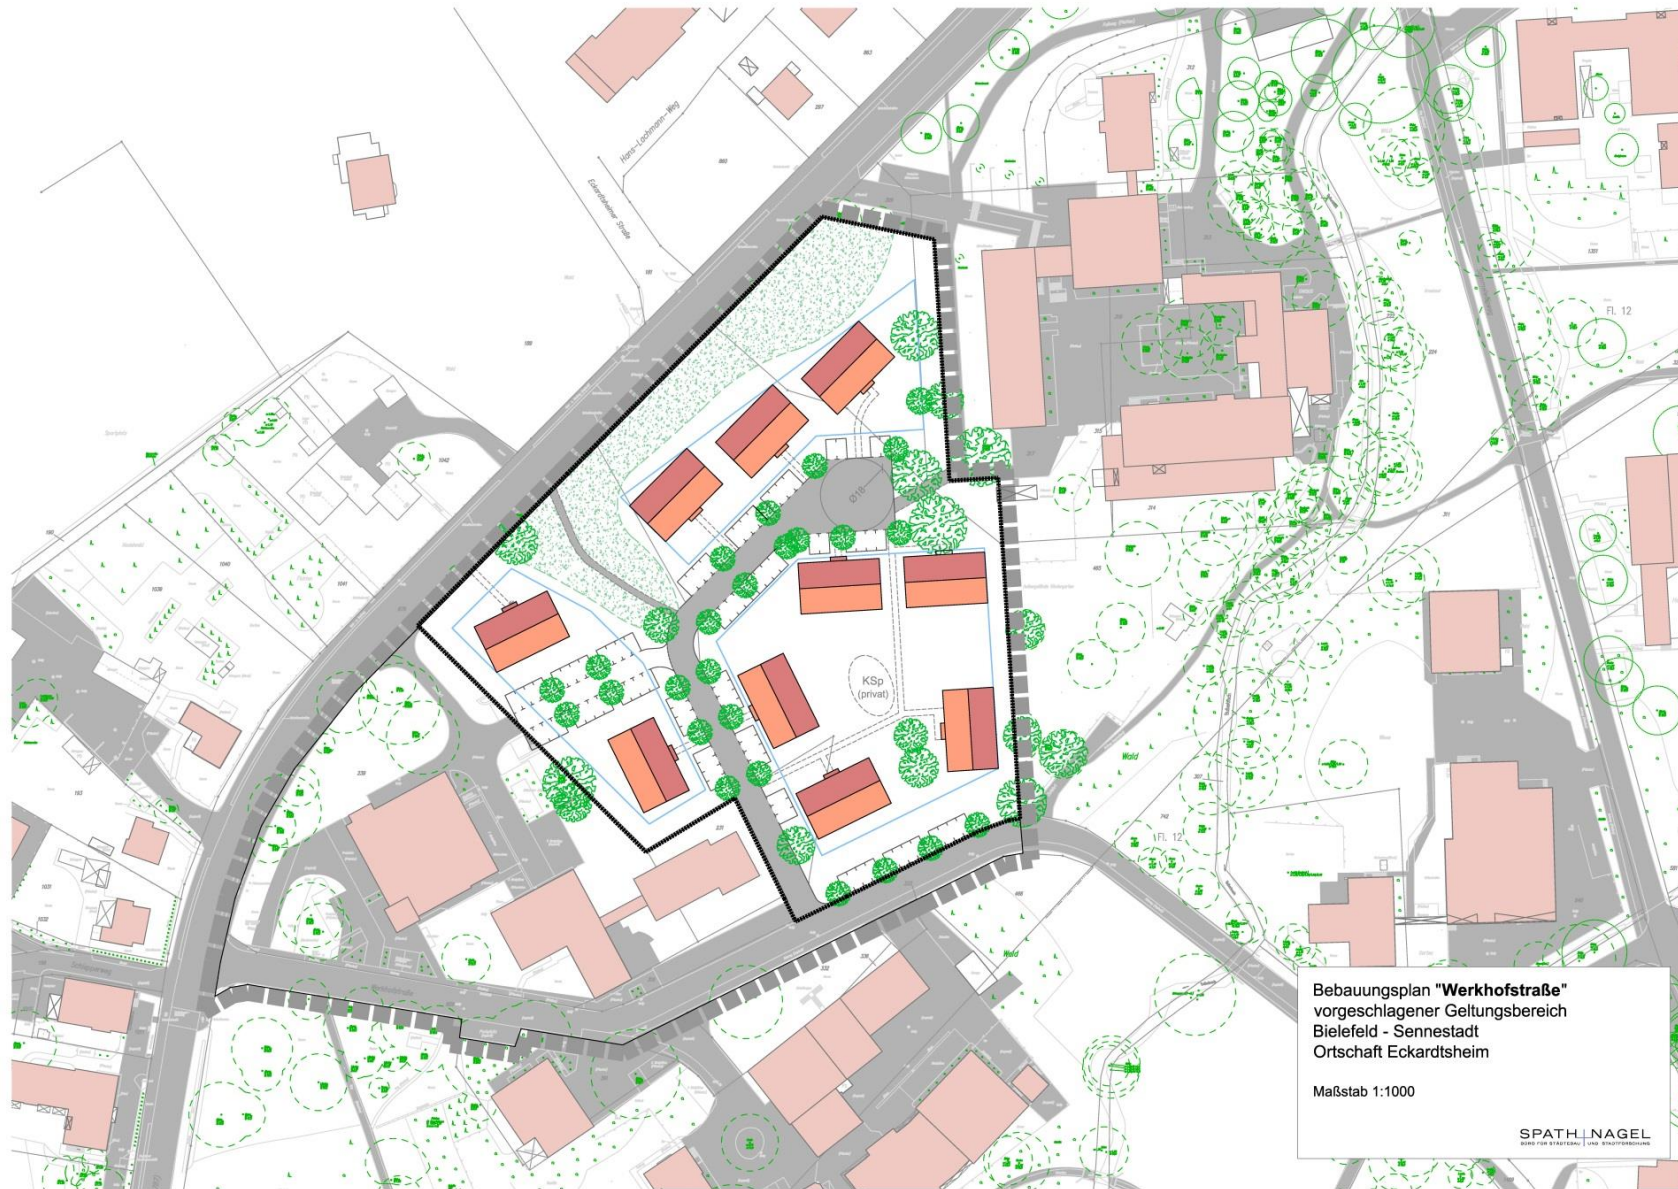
Bebauungsplan „Werkhofstraße“ (vorgeschlagener Geltungsbereich)
